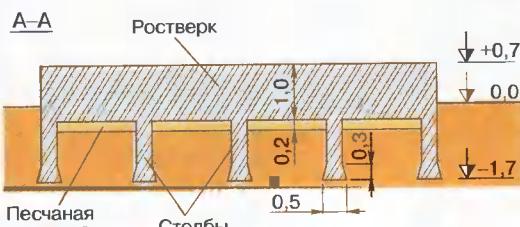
Разрез фундамента A-A (см. рис. 4)
